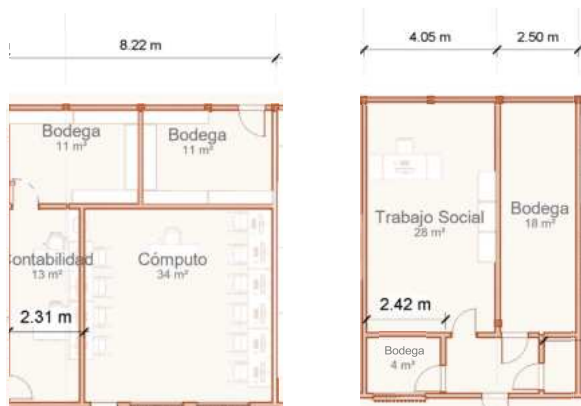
Planta de problemática espacial de contabilidad | Fuente: Elaboración propia
